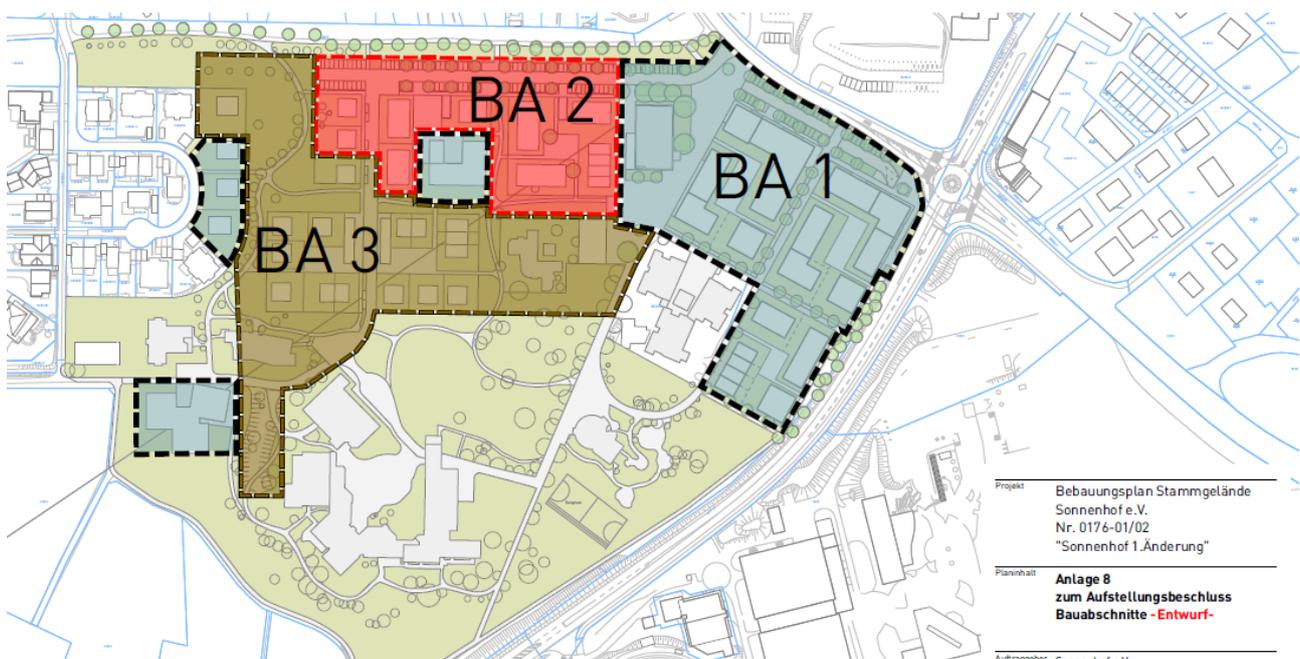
Bauabschnitte des Bebauungsplans Sonnenhof - 1. Änderung - Entwurf (CITIPLAN STAND 22.03.2018)
